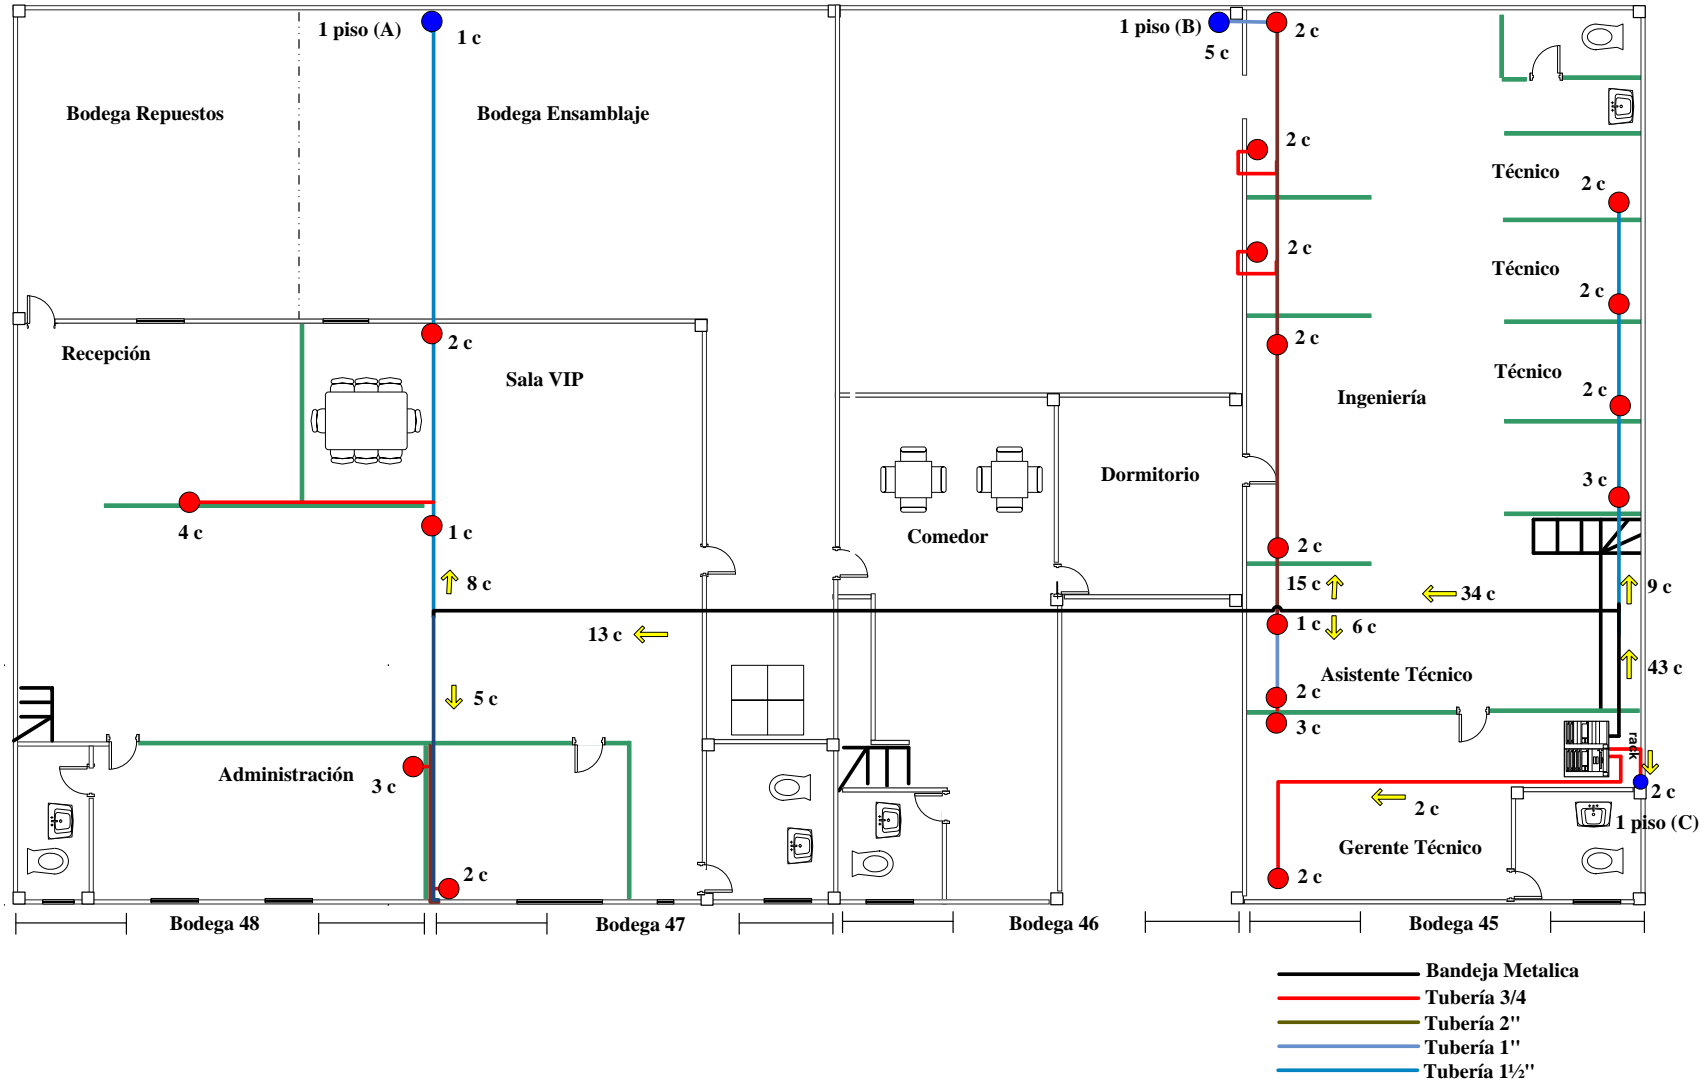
Diseño de rutas de tubería y cable UTP del Sistema de Cableado Estructurado Segundo Piso
